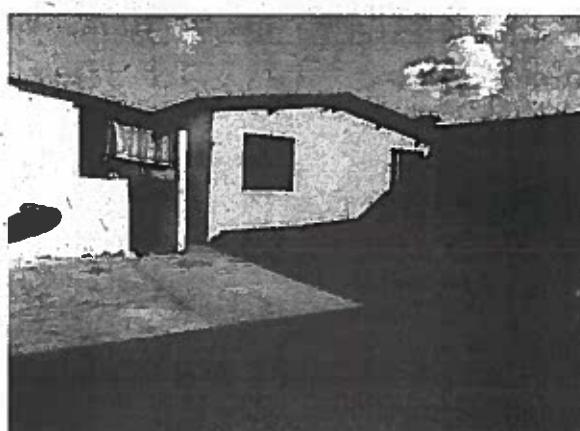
Casa principal e Edícula lateral (vista frontal)
